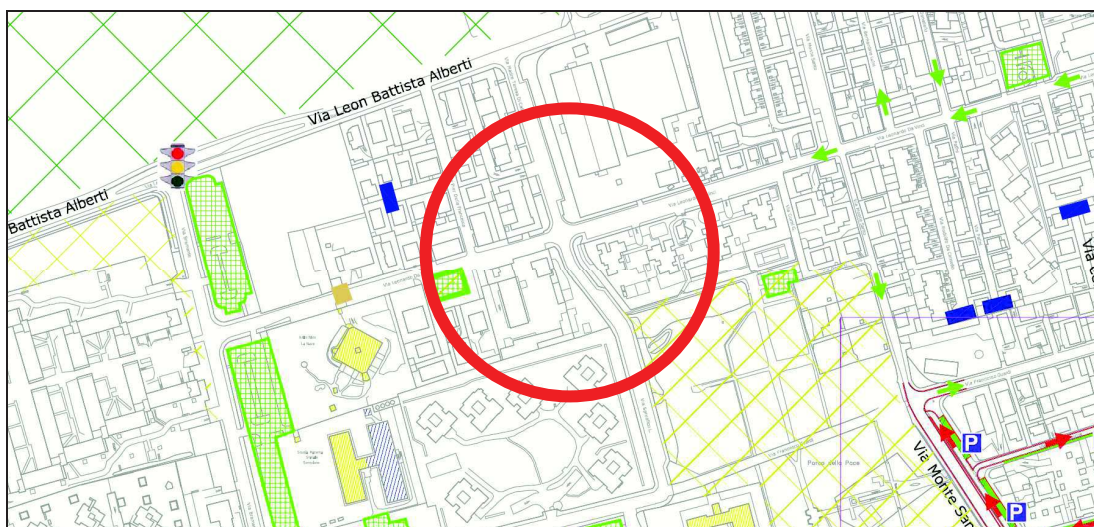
INTERSEZIONE 1 Estratto planimetrico, Aggiornamento PGTU (Tavola 9 Interventi proposti)
